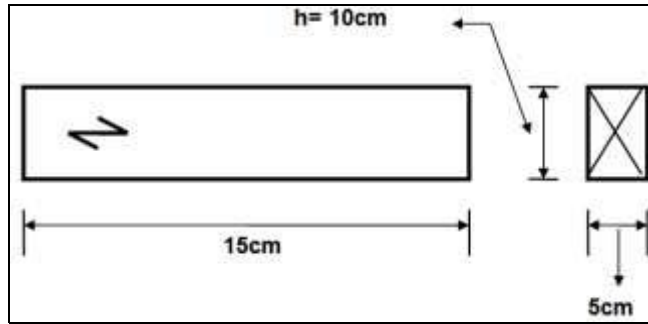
Descrição das peças de madeira para ensaio de tração perpendicular as fibras da madeira Fonte: Adaptado de CALIL (2002)
